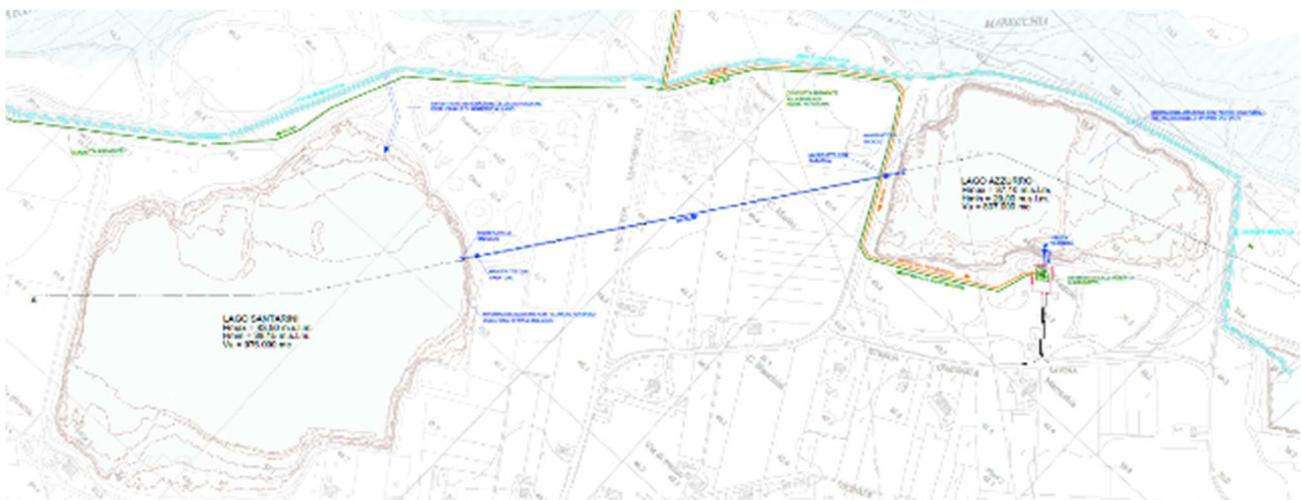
Planimetria di progetto dei laghi del Progetto di fattibilità tecnica ed economica
